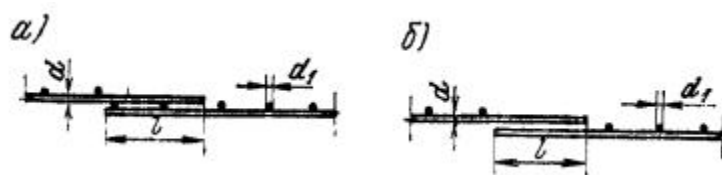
Стыки сварных сеток внахлестку (без сварки) в направлении рабочей арматуры, выполненной из стержней периодического профиля
